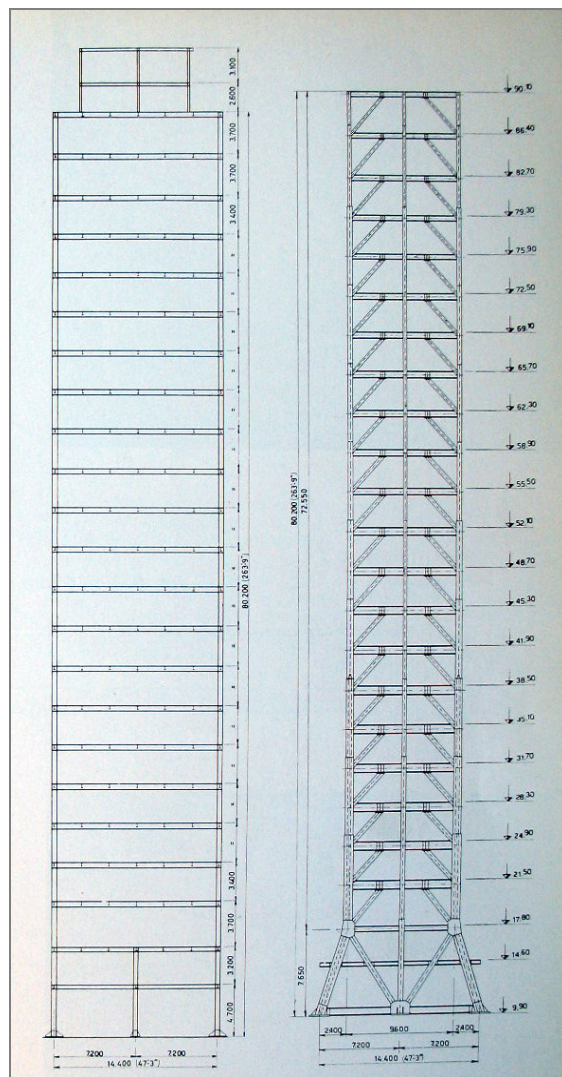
sezione trasversale dell'edificio e pareti verticali di controventamento
